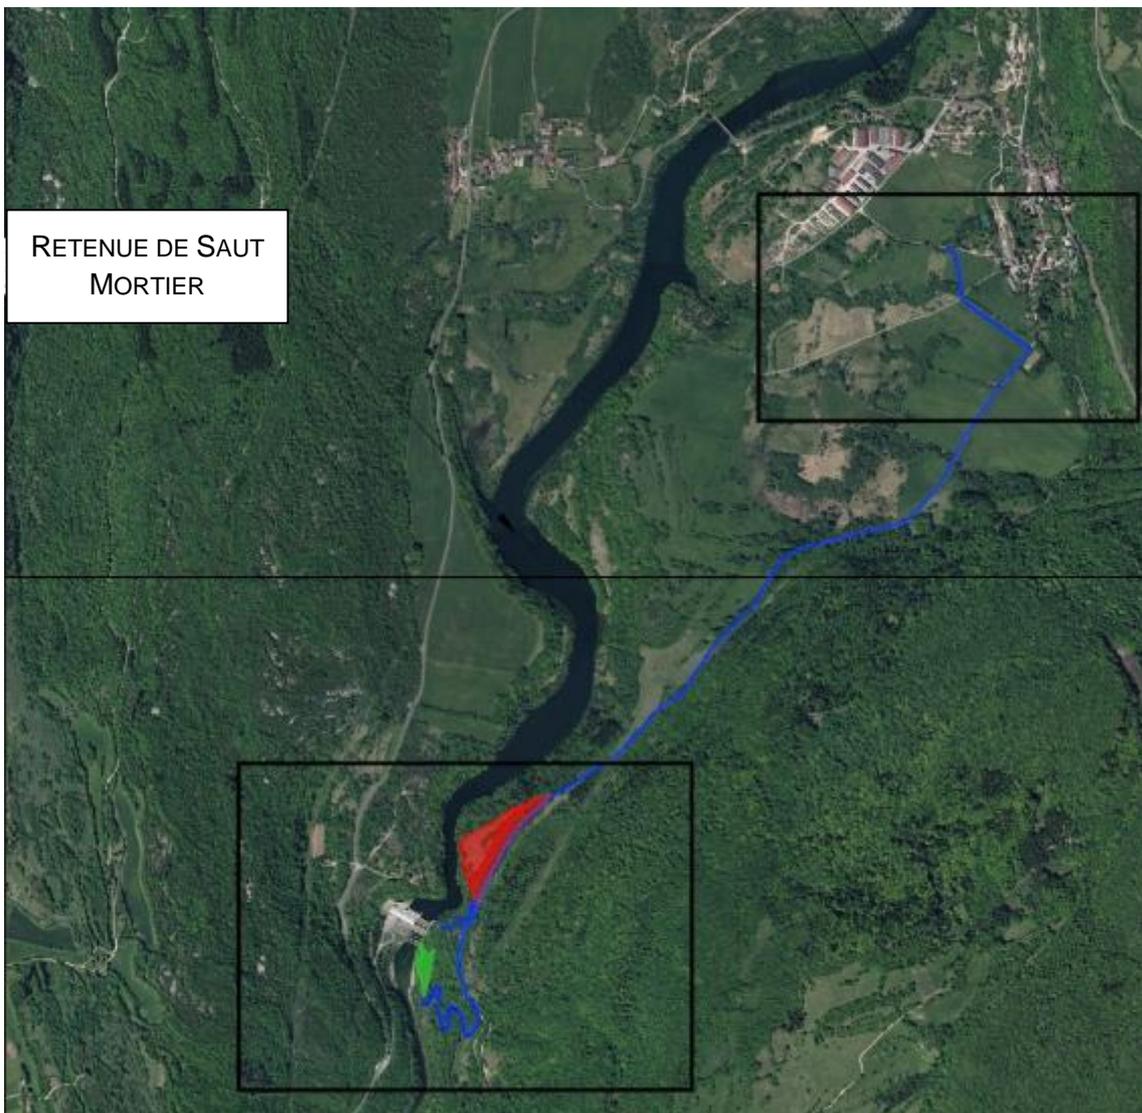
Vue en plan de la piste d'accès (bleu) et des plateformes (vert et rouge)
